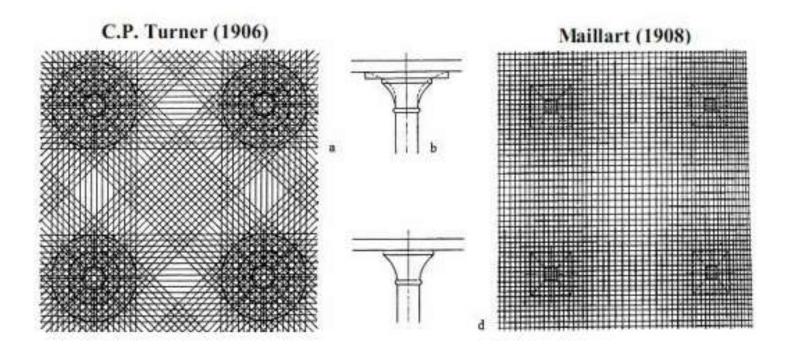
Modelo de lajes planas apoiadas sobre pilares – Turner e Maillart Fonte: LIMA et al. (2004)
